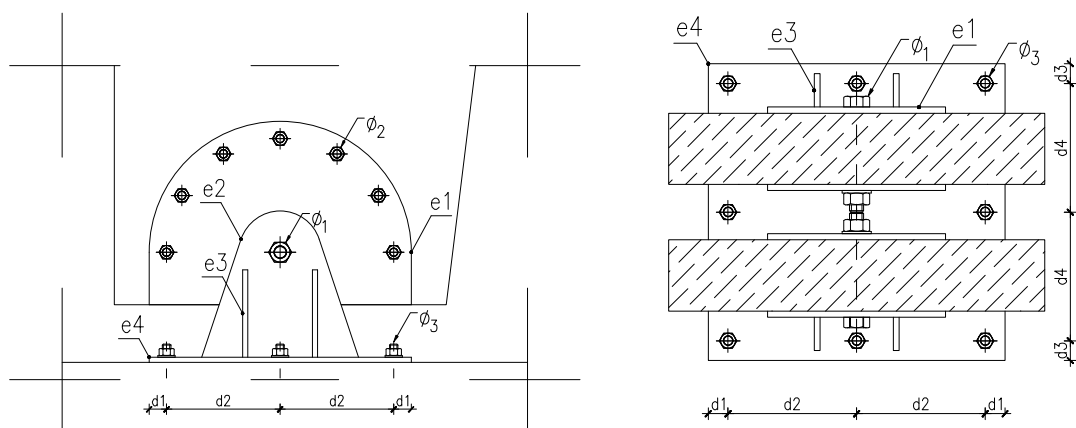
Esquema genérico da ligação dos pilares à base: alçado e planta (s/ escala).
